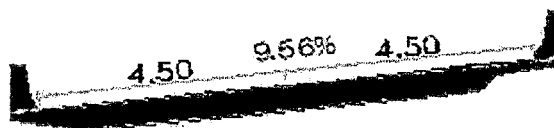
Sección transversal de un puente en curva - Fuente. Elaboración Propia
